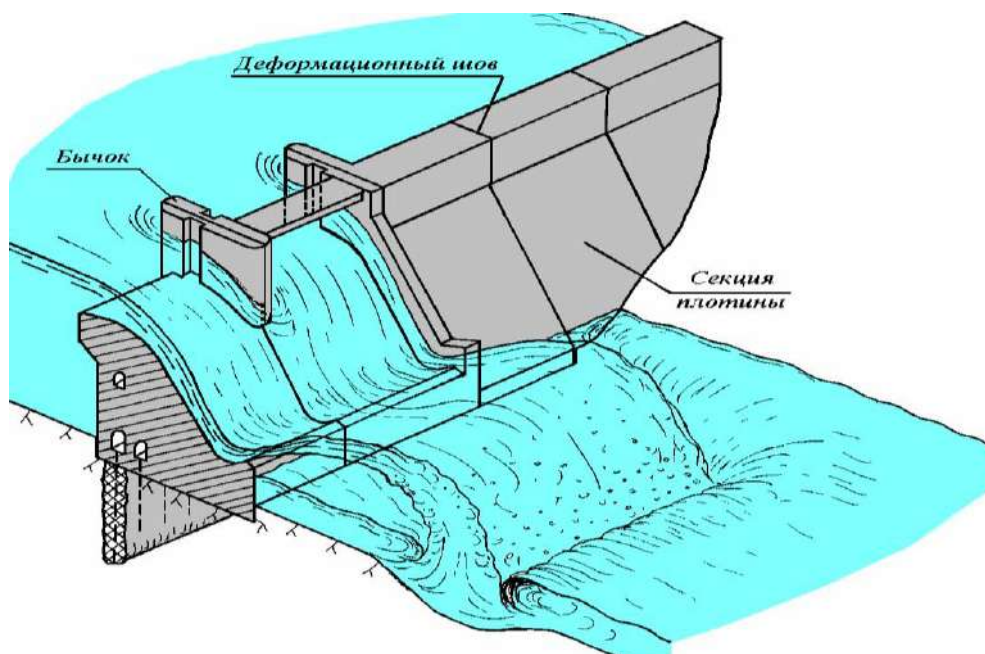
Бетонная плотина с глухими и водосбросными секциями
